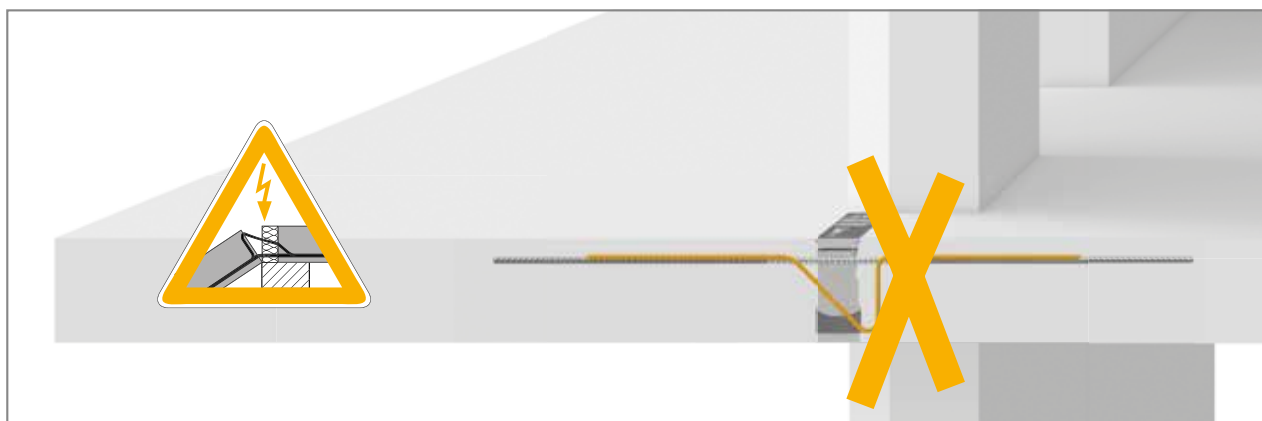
Schöck Isokorb® T tip KL: prenašanje prečne sile
